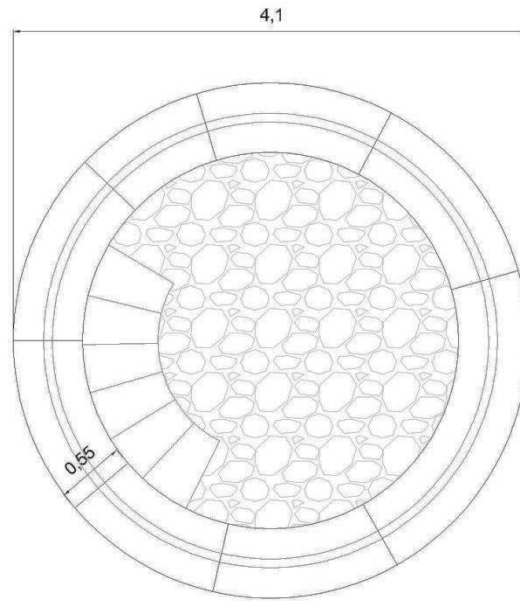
Planta de vista aérea do moinho. Fonte: Autor
